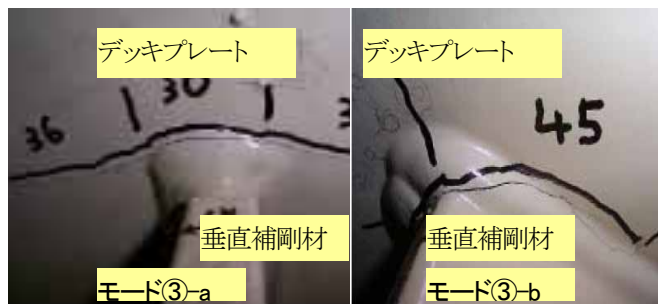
垂直補剛材とデッキプレート溶接部の疲労き裂モード
